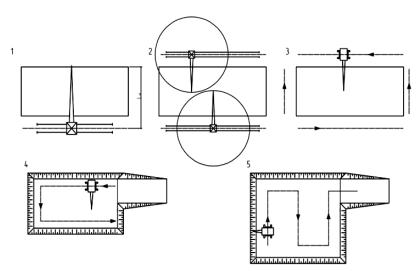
Схема устройства фундаментов многоэтажного здания: по первой и второй схемам фундаменты монтируют башенными кранами или кранами-нулевиками; по третьей, четвертой и пятой схемам фундаменты монтируют самоходными стреловыми кранами
